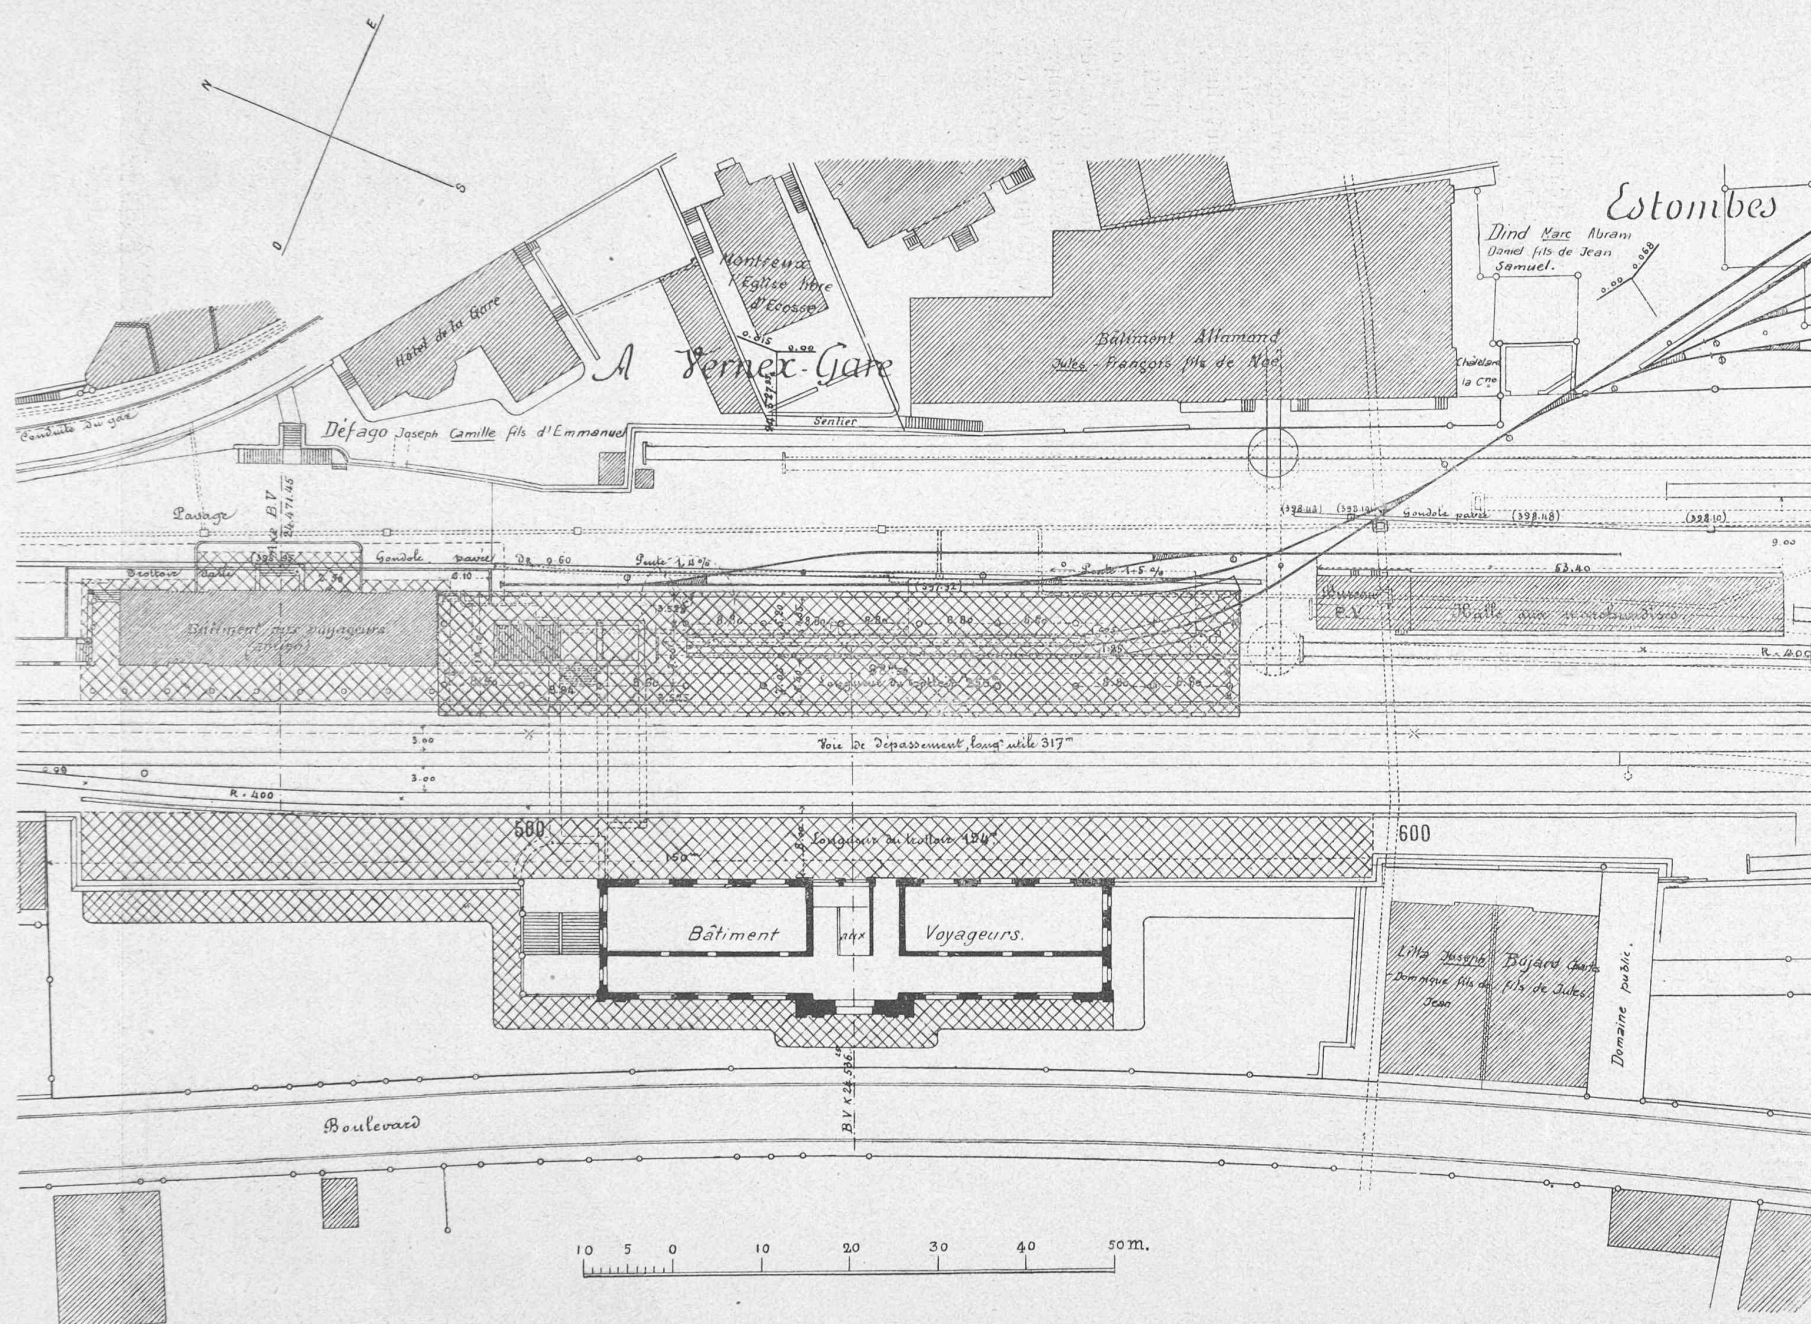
Bâtiment aux voyageurs de la gare de Montreux. — Plan de situation.
